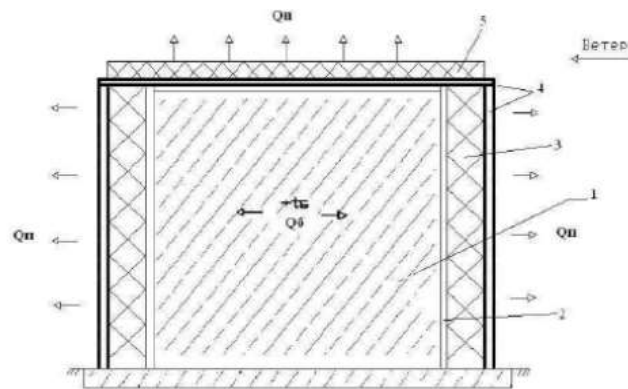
Схема на выдерживание бетона конструкции методом термоса
